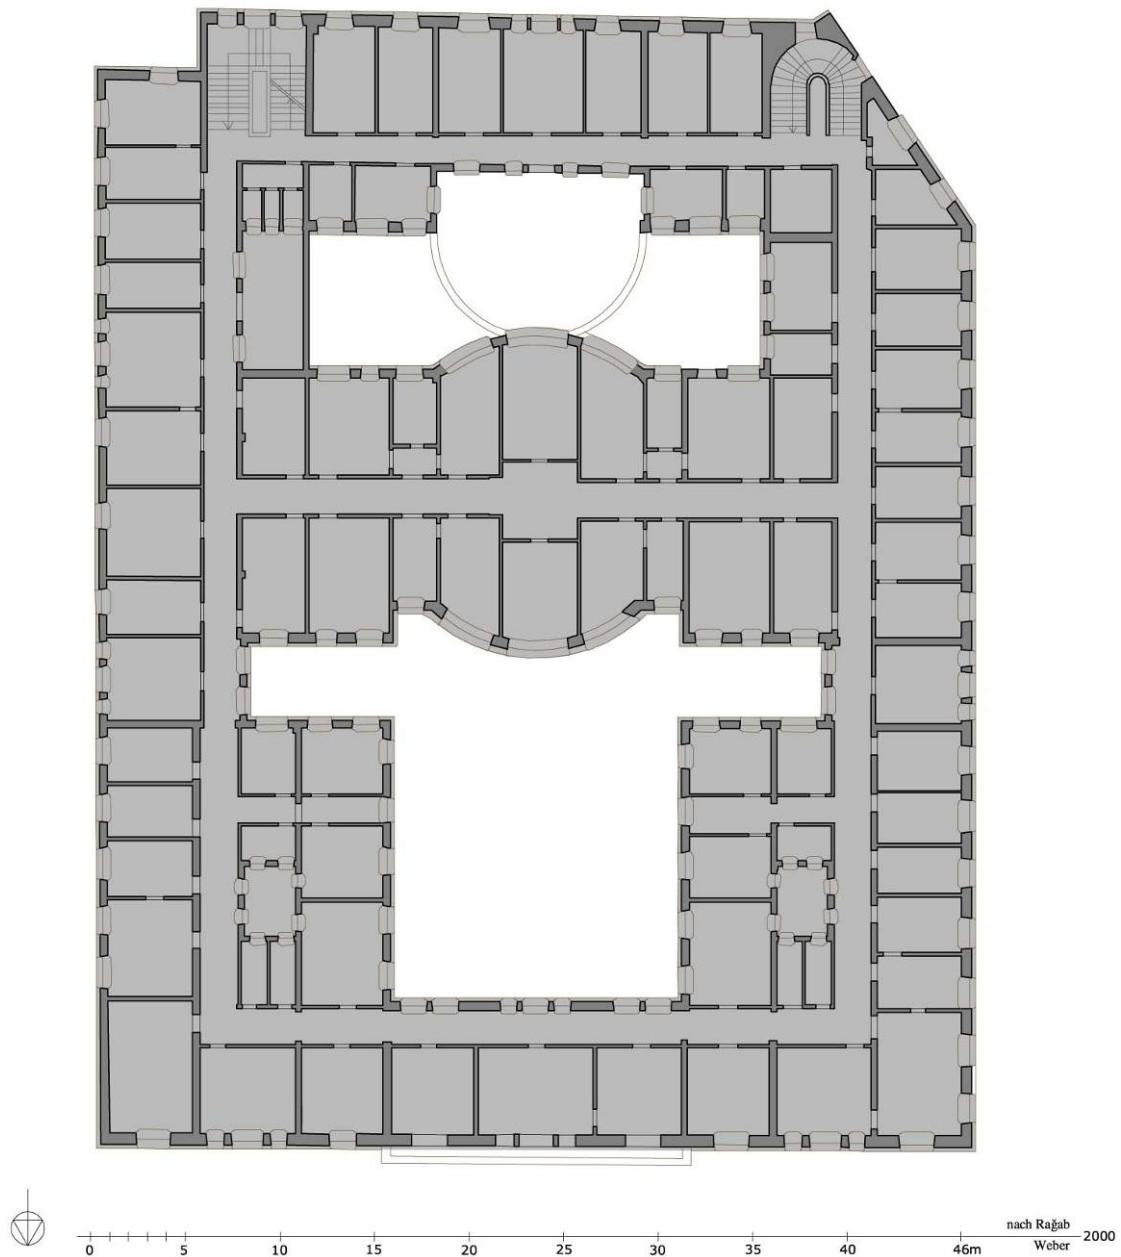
Handelsgebäude al-ʿĀbid, Grundriss 2. OG
